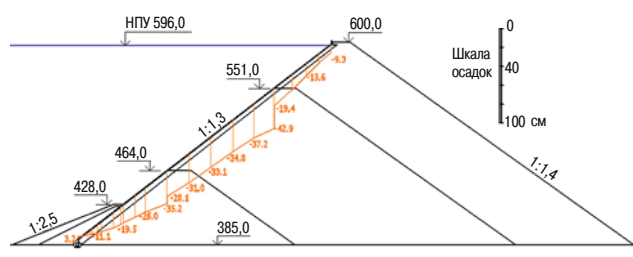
Вертикальные перемещения железобетонного экрана, см, для варианта 3
